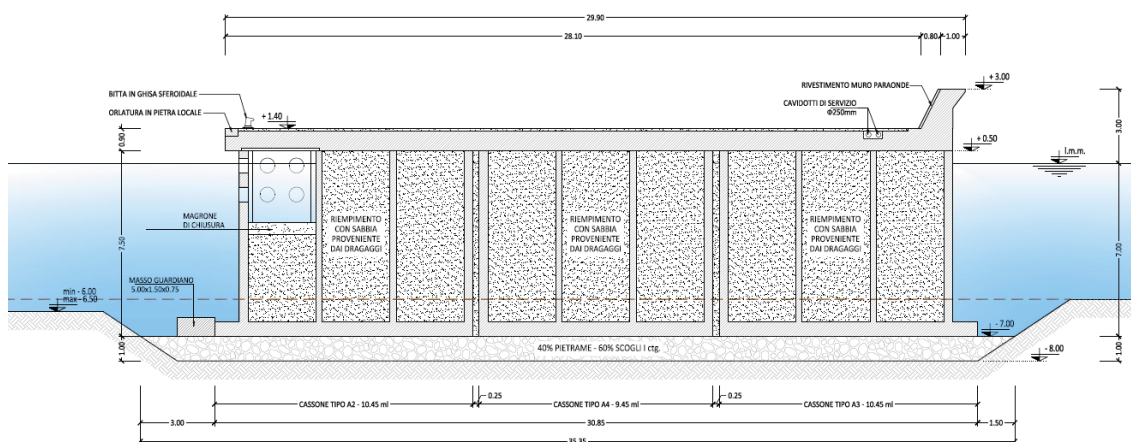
Sezioni tipo prolungamento molo di Levante – Tratto di testa
